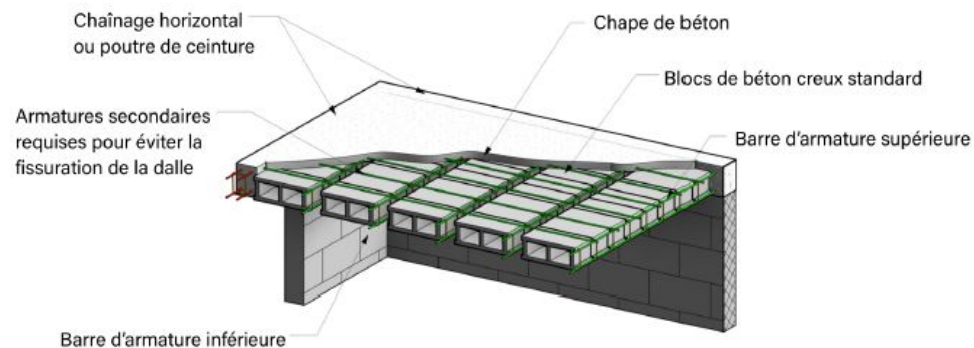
Caractéristique d'une dalle alvéolée
